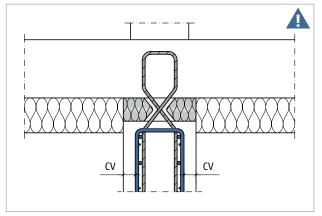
Schöck Sconnex® Typ W-N-VH: Variante A – bauseitige Bewehrung; die außenliegende Längsbewehrung stützt die Querkraftstäbe des Schöck Sconnex® gegen die Bauteiloberfläche ab
